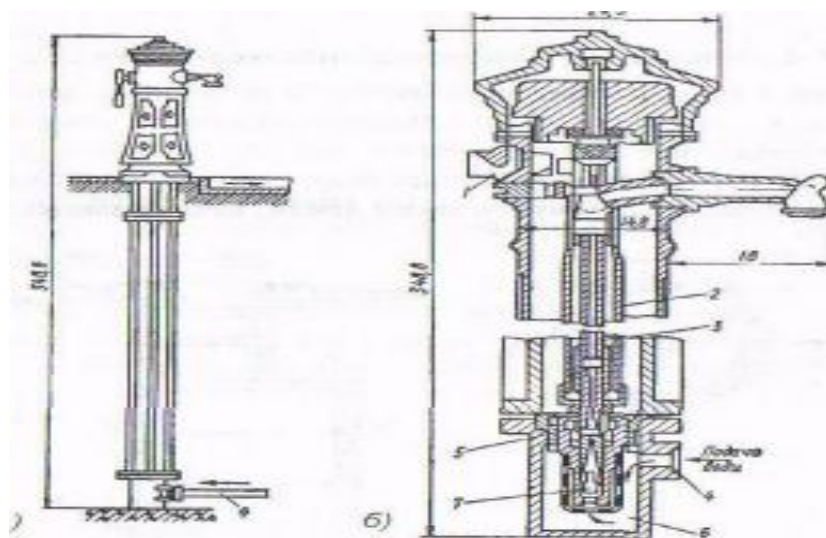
13. Водорозбірна колонка: а—загальний вигляд; б — деталь верхньої частини; 1 — піднімальний важіль з рукояткою; 2 — трубчаста штанга; 3 — подаюча труба; 4 — патрубок; 5 ежектор; 6 — приймальний бачок; 7 — клапан
